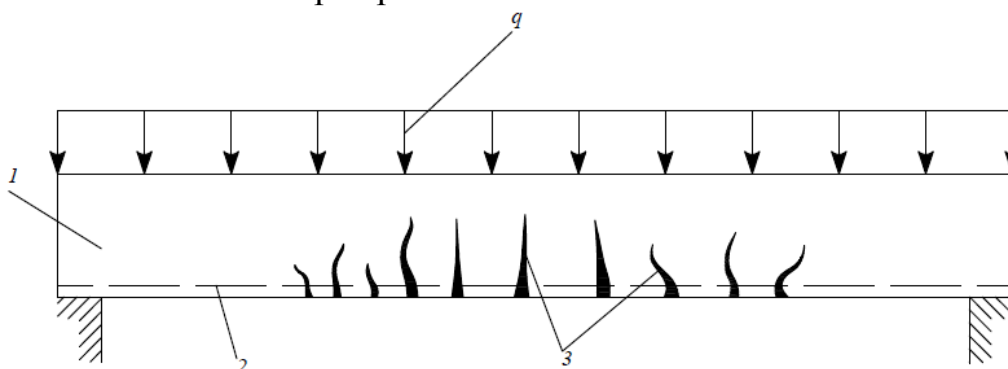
Трещины в нормальном сечении железобетонных изгибаемых
